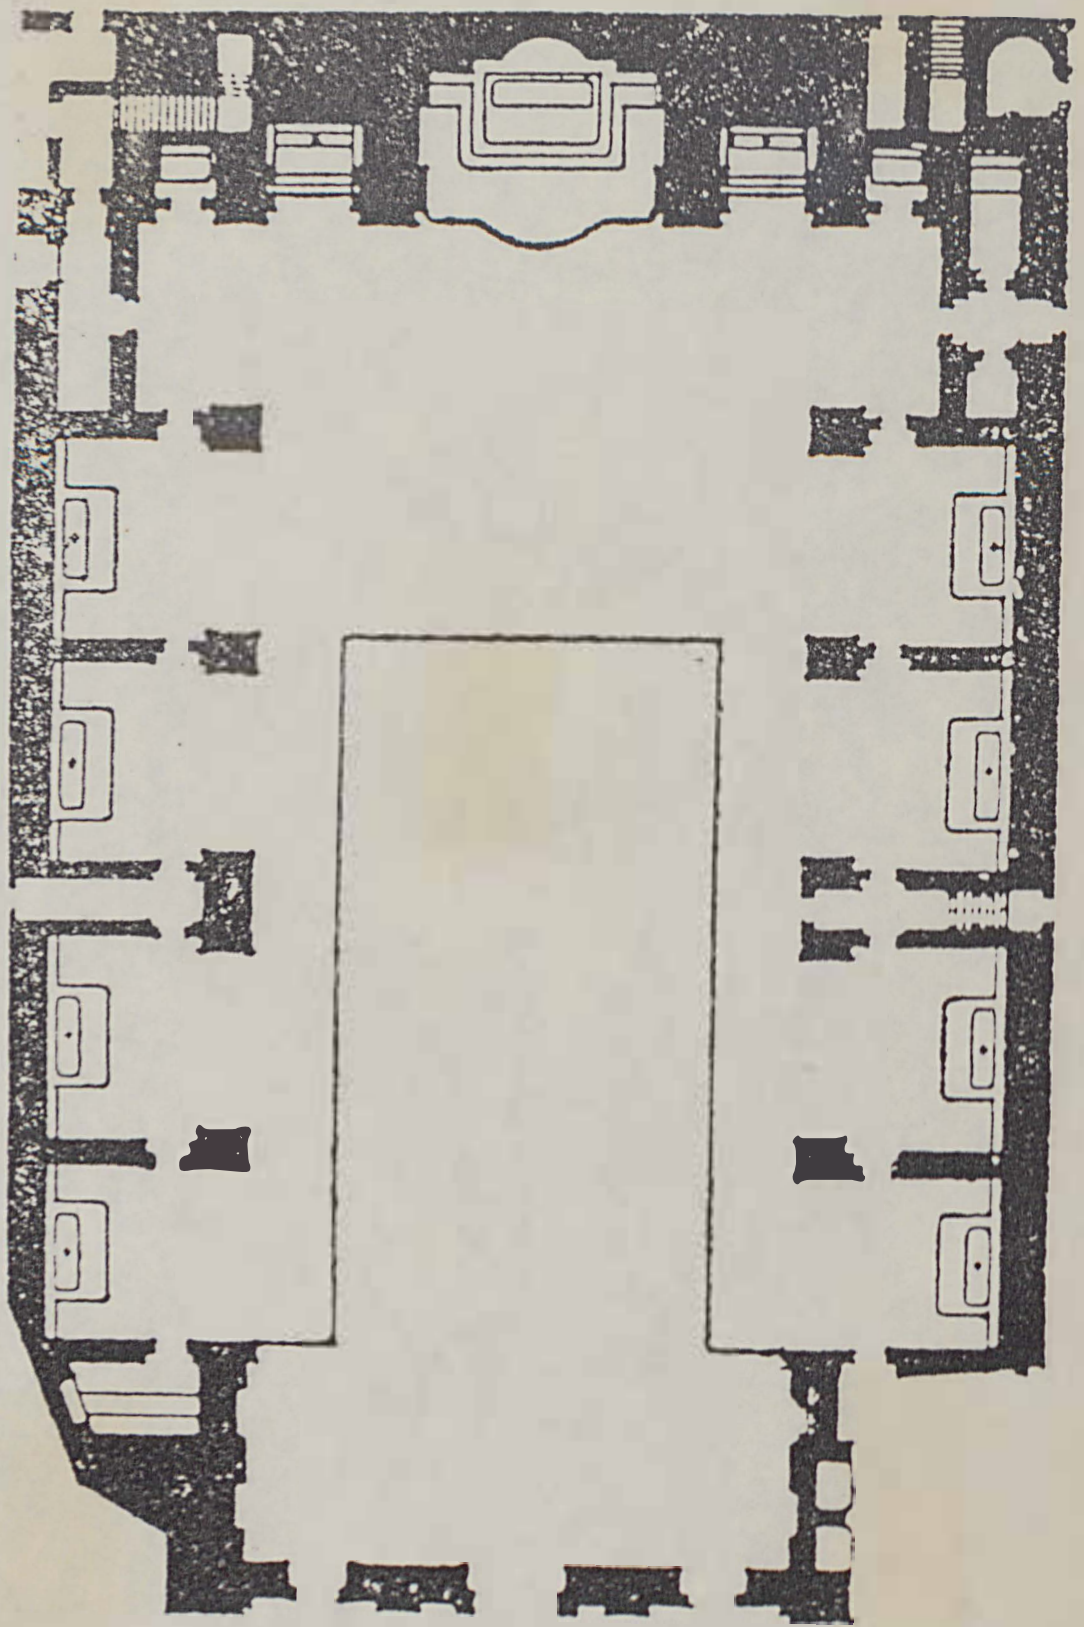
Planta da Igreja de São Roque em Lisboa, Portugal (c. 1565).
